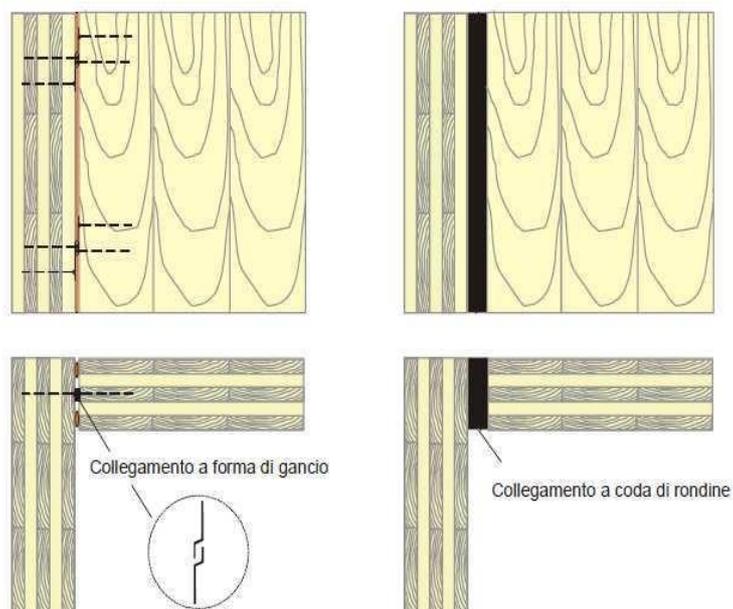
Giunzione parete-parete, possibilità di realizzazione del collegamento d'angolo mediante bullonatura e profili di legno.
